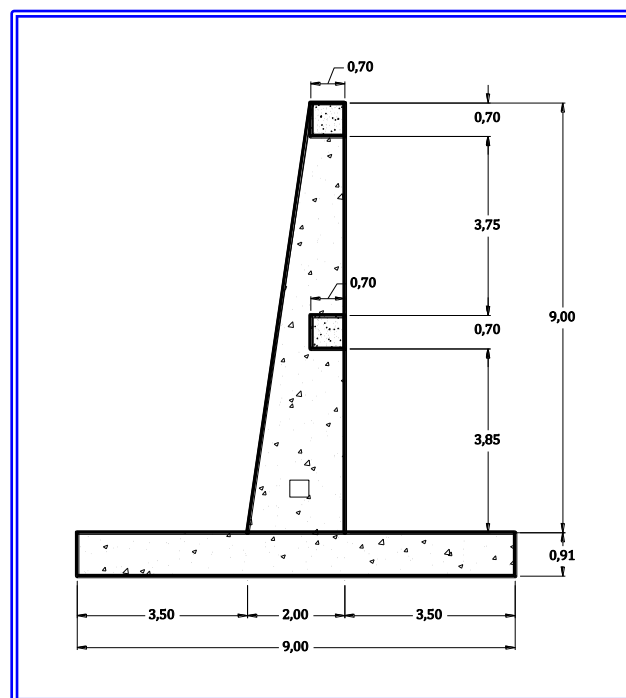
Vista frontal de presa con diente de 7 metros con viga de amarre.
